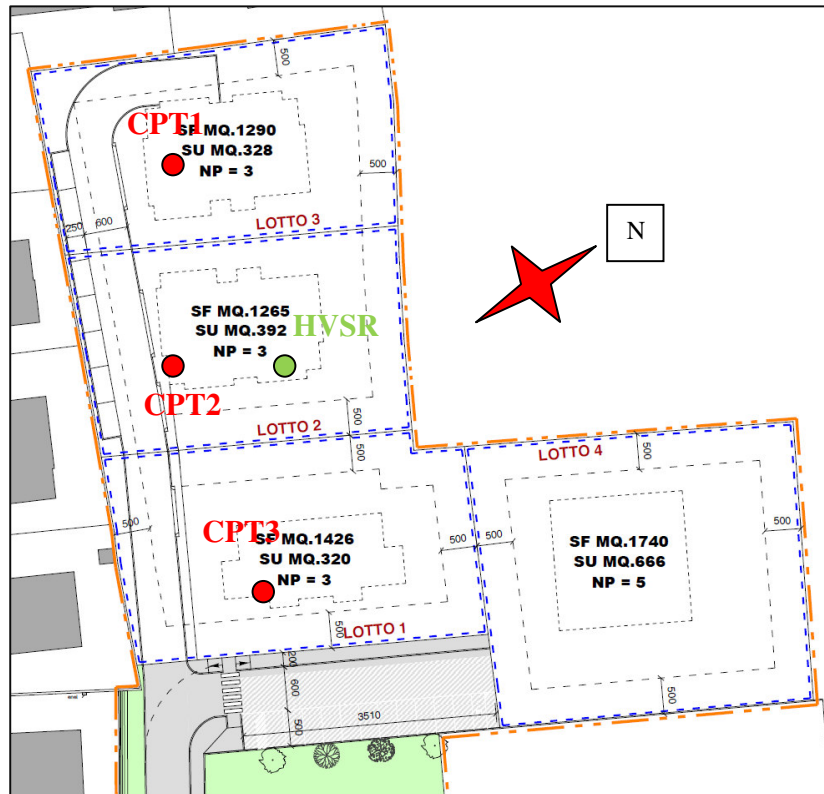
Ubicazione prove penetrometriche su estratto planimetria di progetto. Scala 1: 1.000
